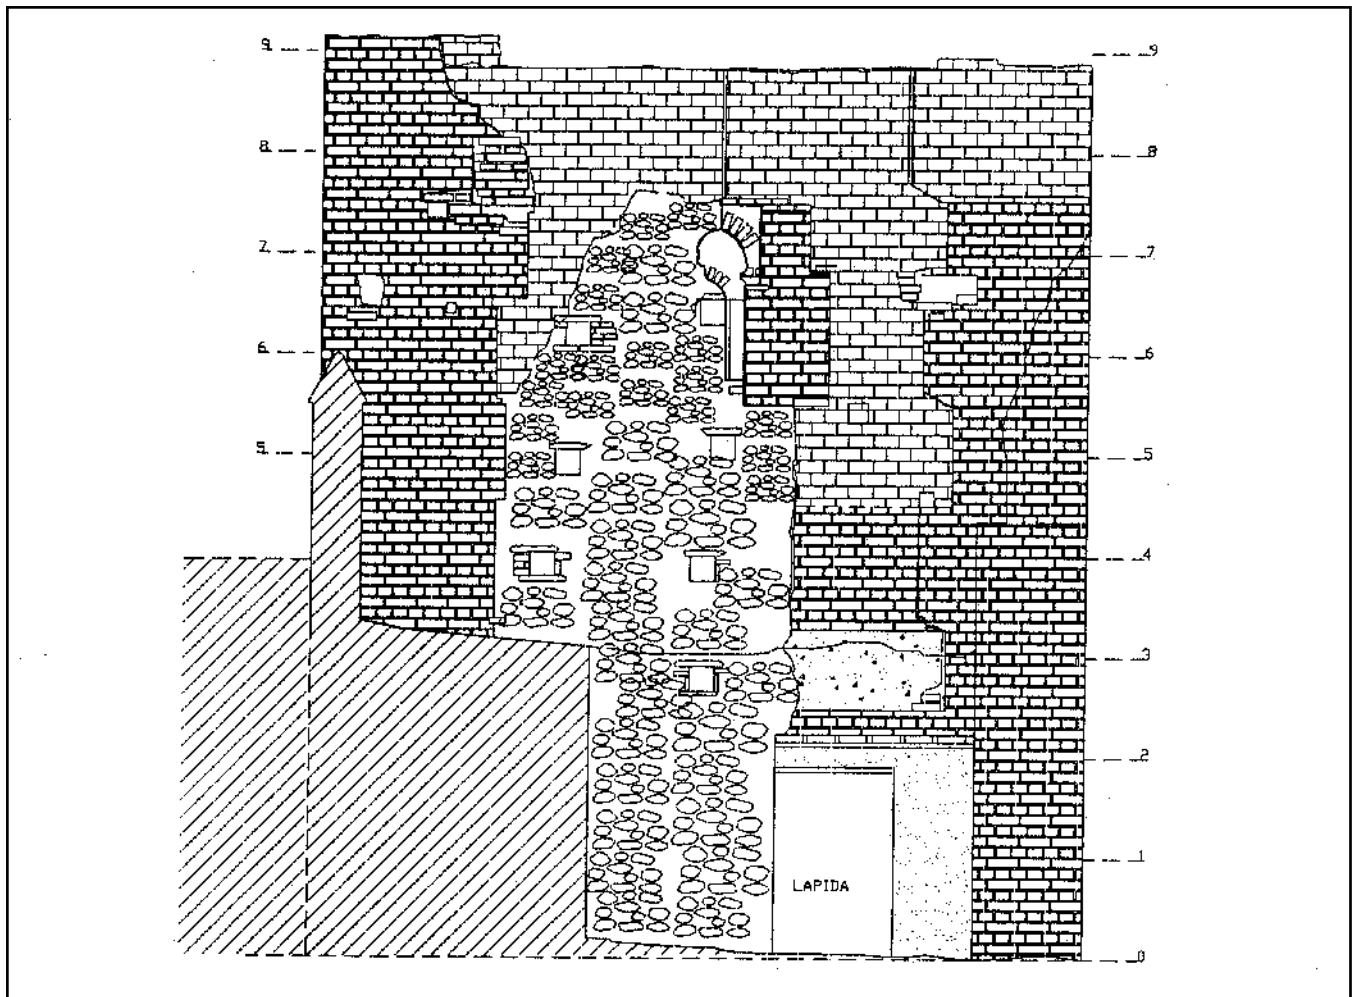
(ZP/97) Lienzo Norte Exterior: Alzado. E. 1:50.
